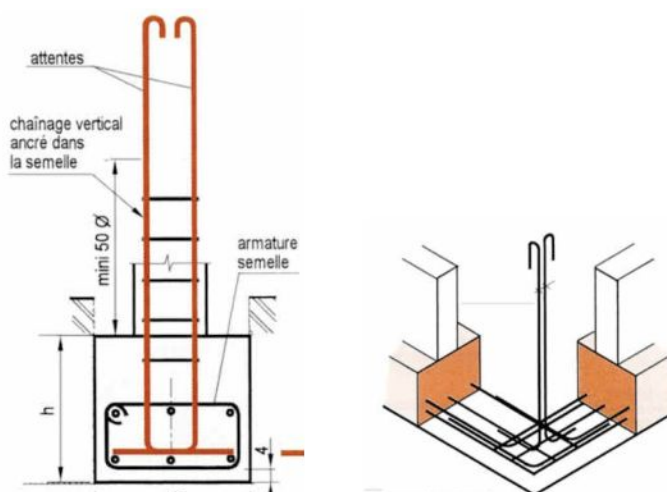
ancrage des chaînages dans les semelles - Continuité des armatures aux angles par des équerres
